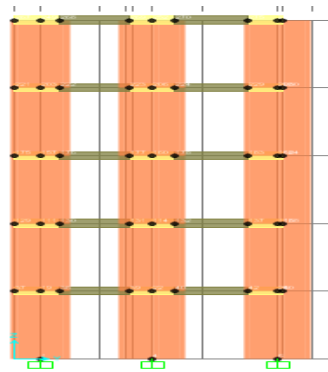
Esquema de un pórtico plano en 3d con SAP2000
